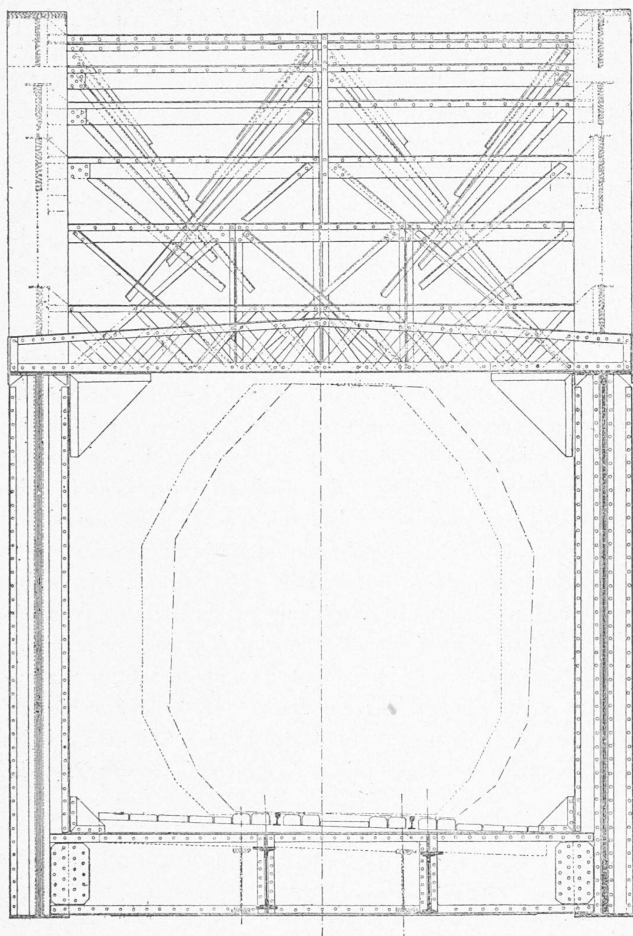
Coupe transversale du pont sur le Kapftobel.
